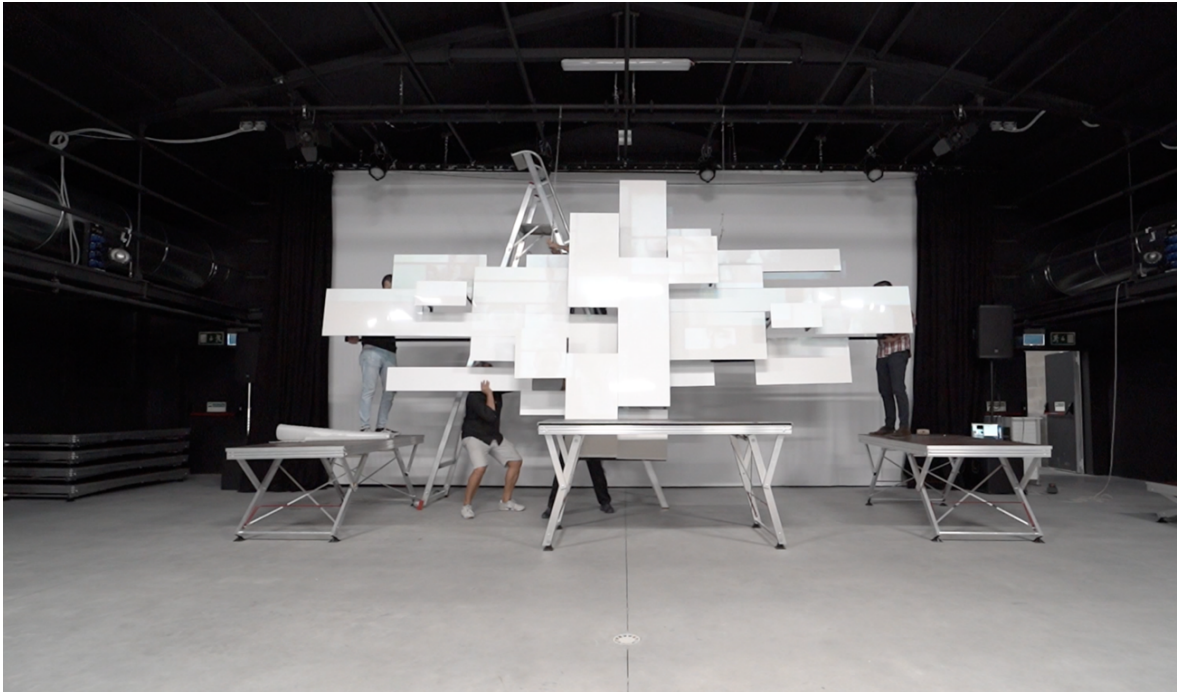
Elevação e suspensão da estrutura completamente montada (1)
